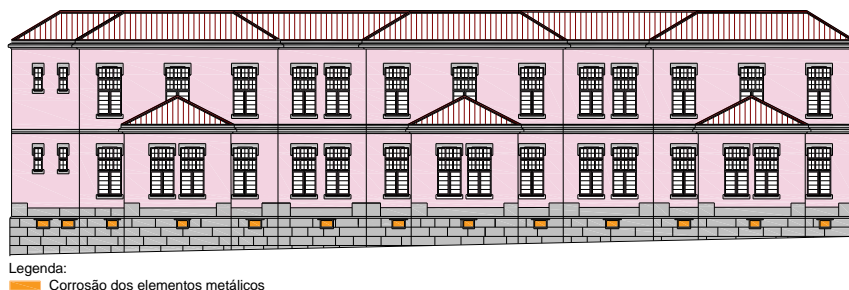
Mapeamento da corrosão nos elementos metálicos na Fachada Lateral Poente [Fonte: Autora]
